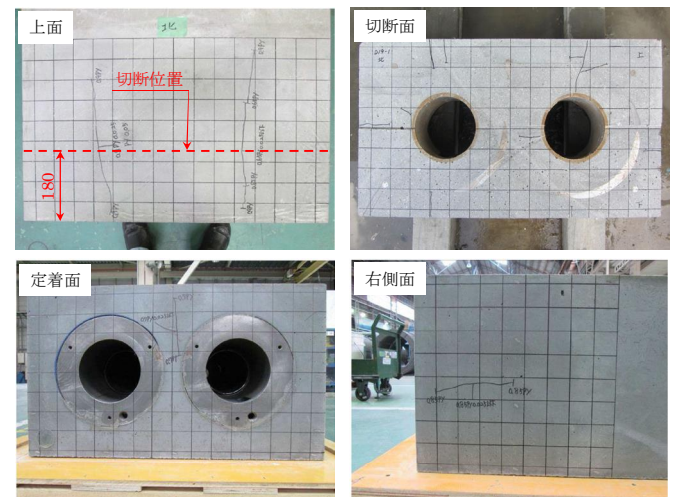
ひび割れの状況 (D19-No.1 北側)
